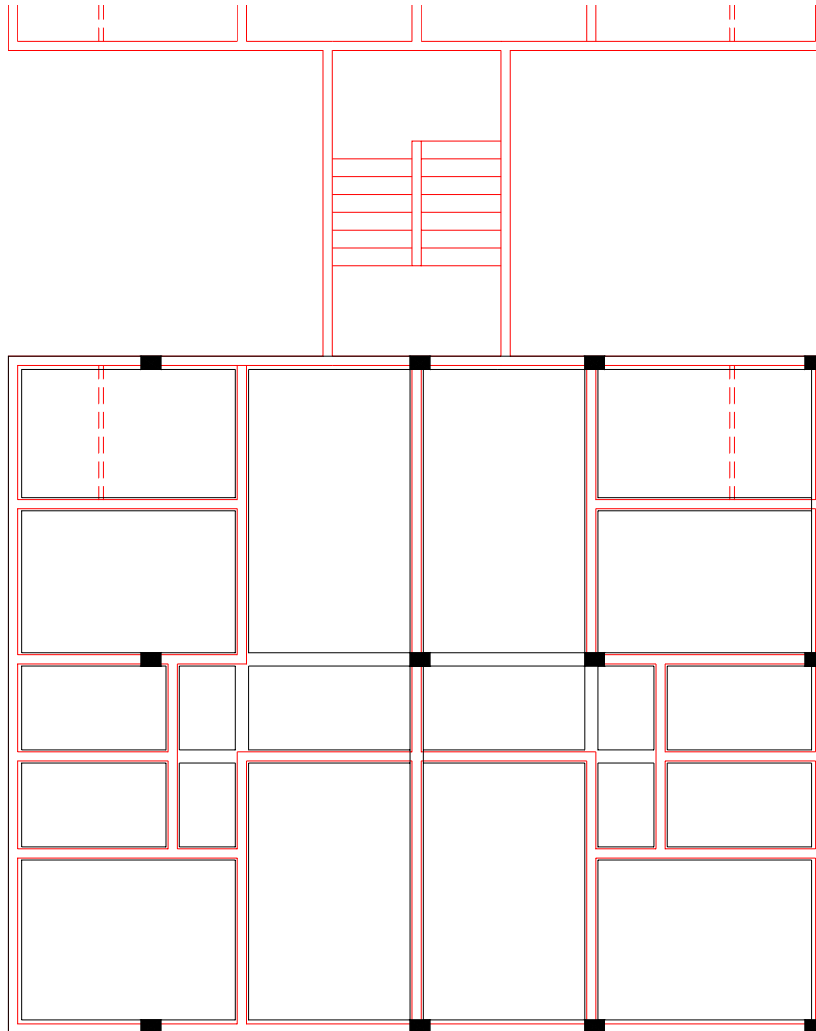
Prédio “C” – Opção 2 – Superposição das alvenarias do pavimento tipo sobre a estrutura
